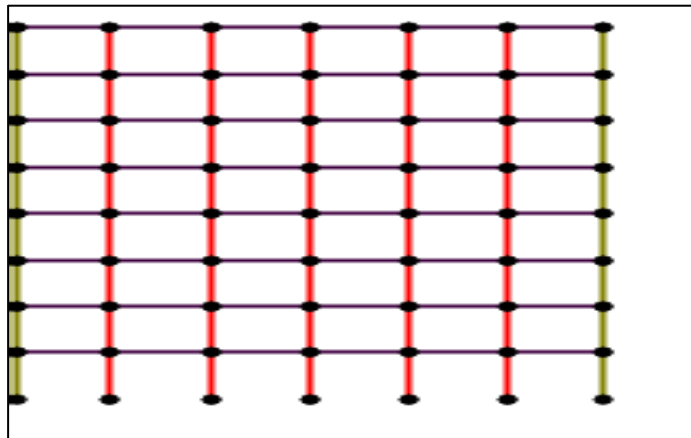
Vue des poteaux et poutres du bloc A.
